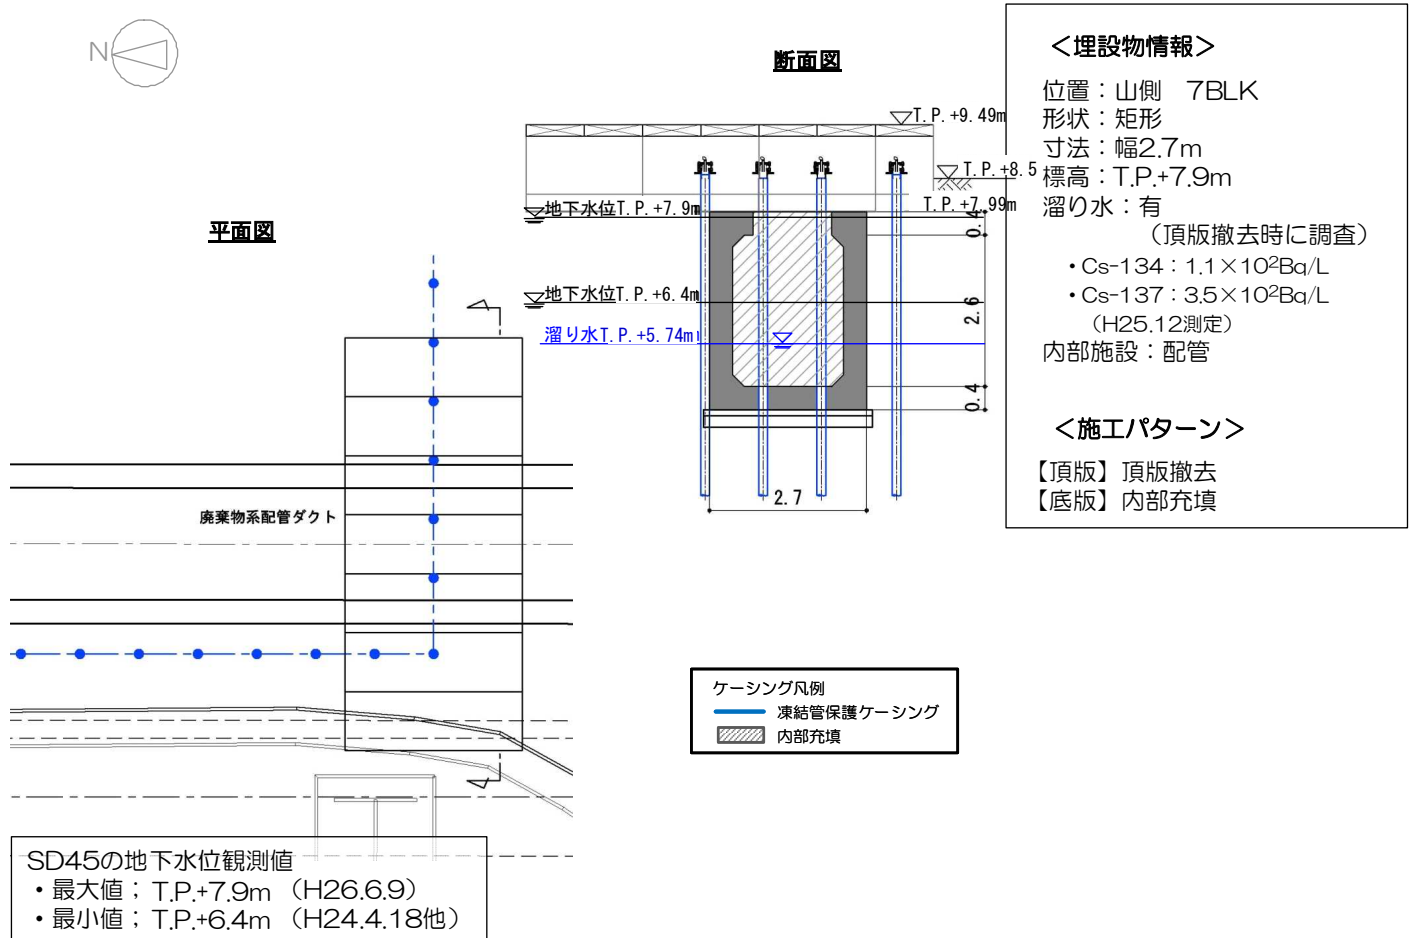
【7-4】 廃棄物系共通配管ダクト① 施工方法 (貫通施工)
